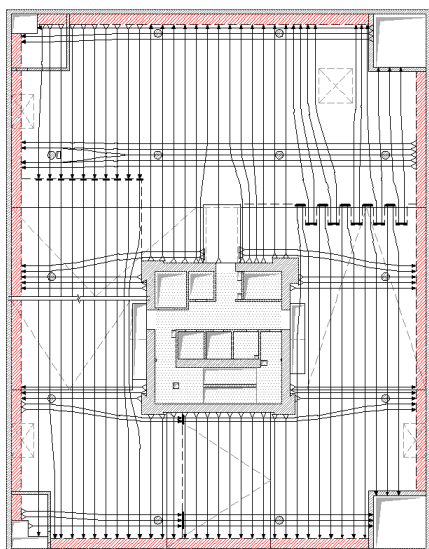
Vista en planta con franja perimetral desvinculada temporalmente.
